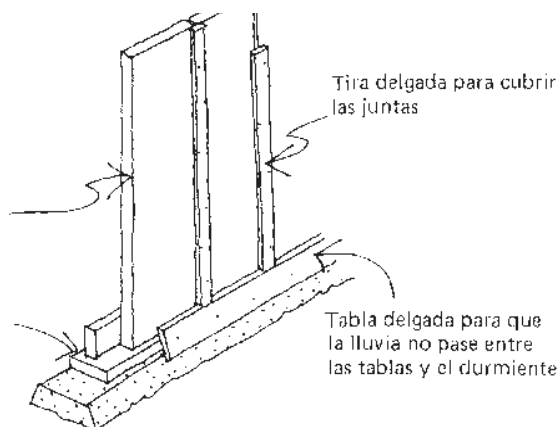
, colocación de cubiertas de madera, Johan Van Lengen
